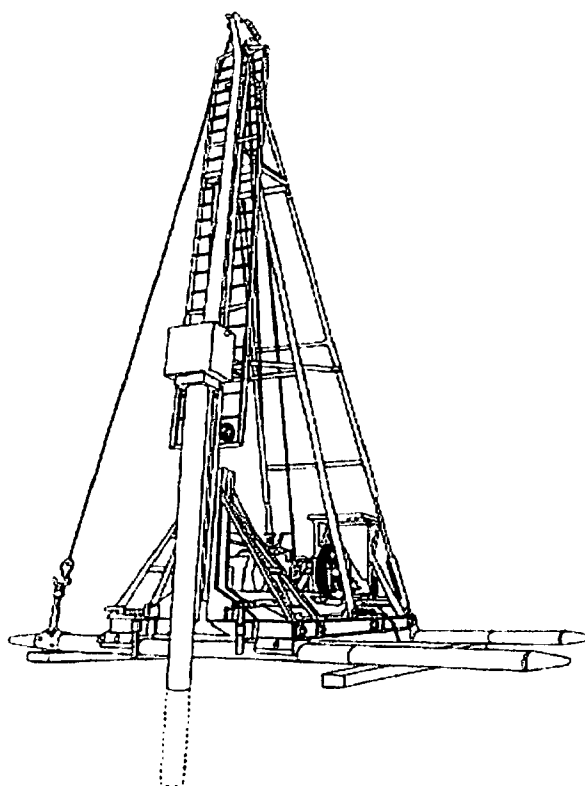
Equipamento para cravação das estacas pré-moldadas de concreto
